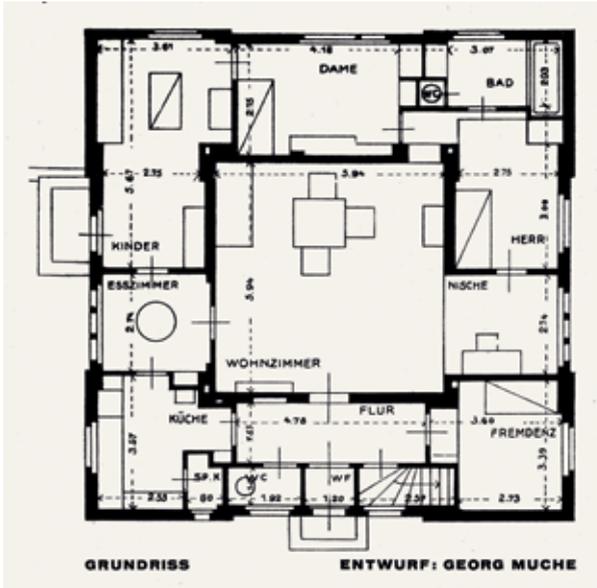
Grundriss, Musterhaus am Horn, 1923.
